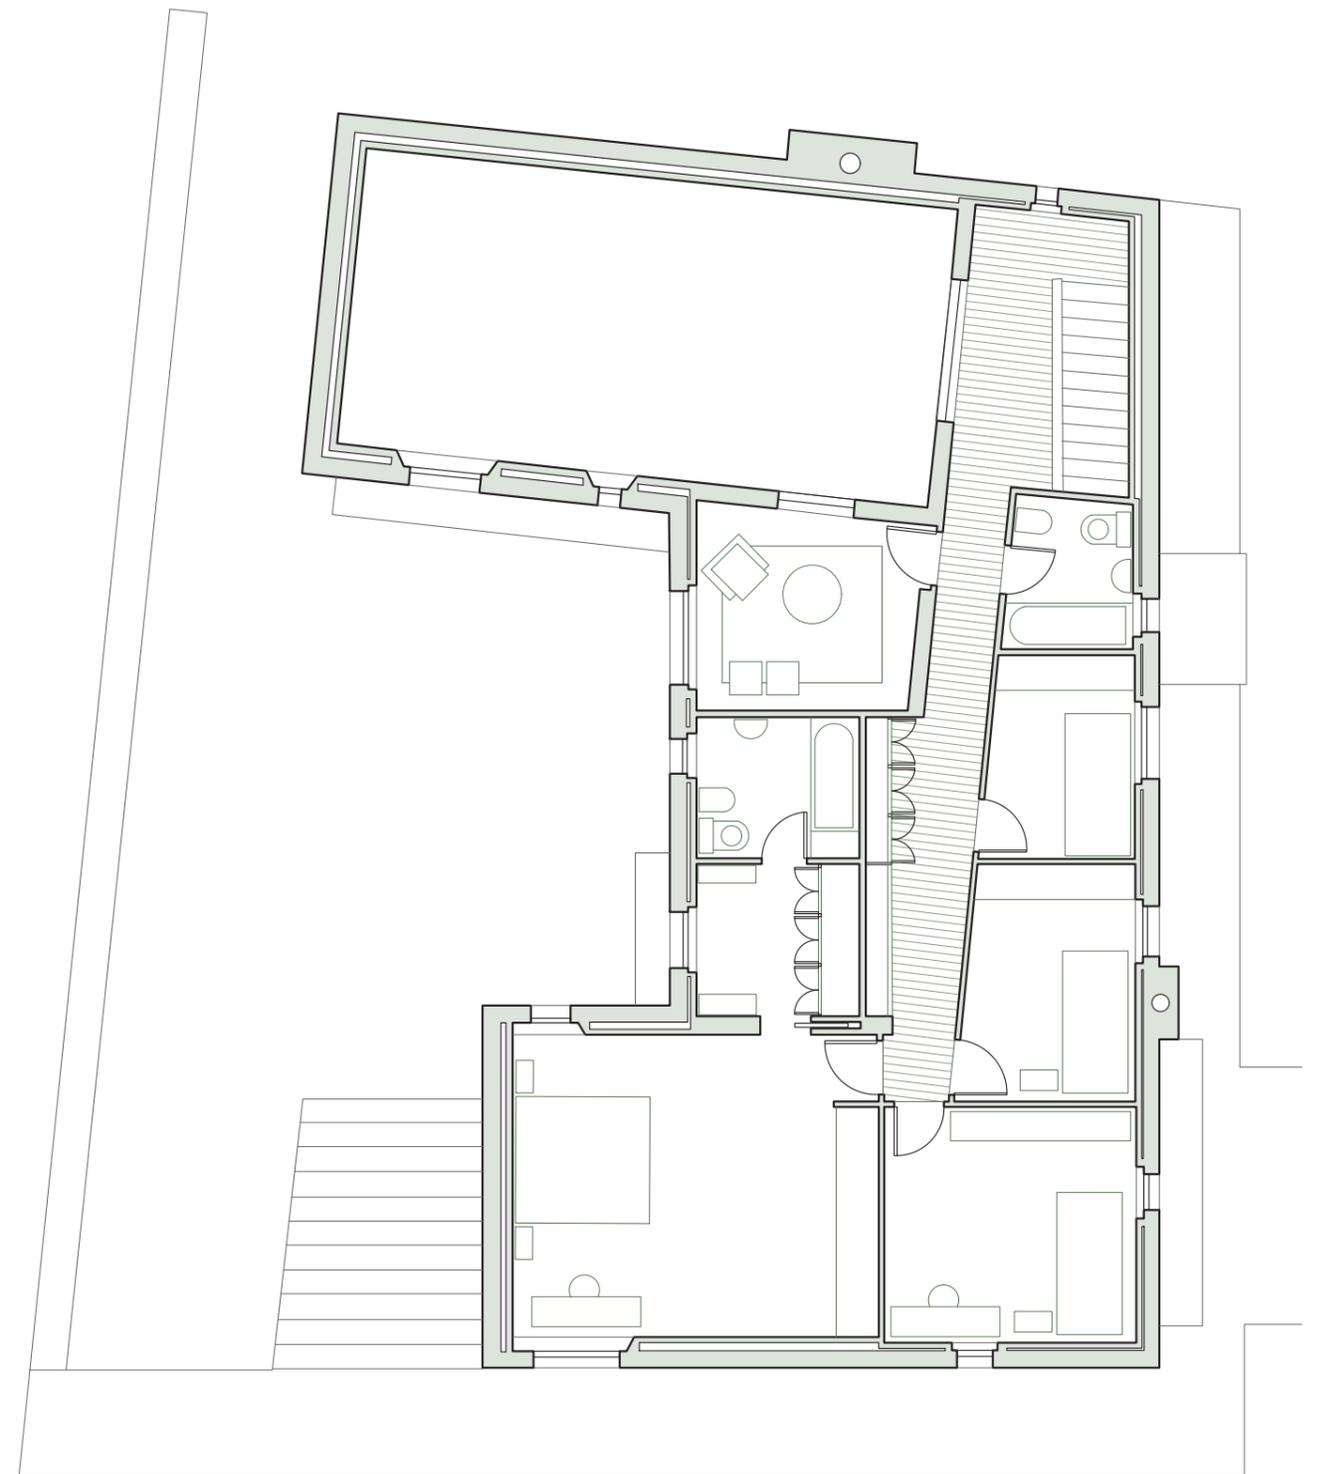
Planta primera. Casa Cerdá. Escala 1:100
